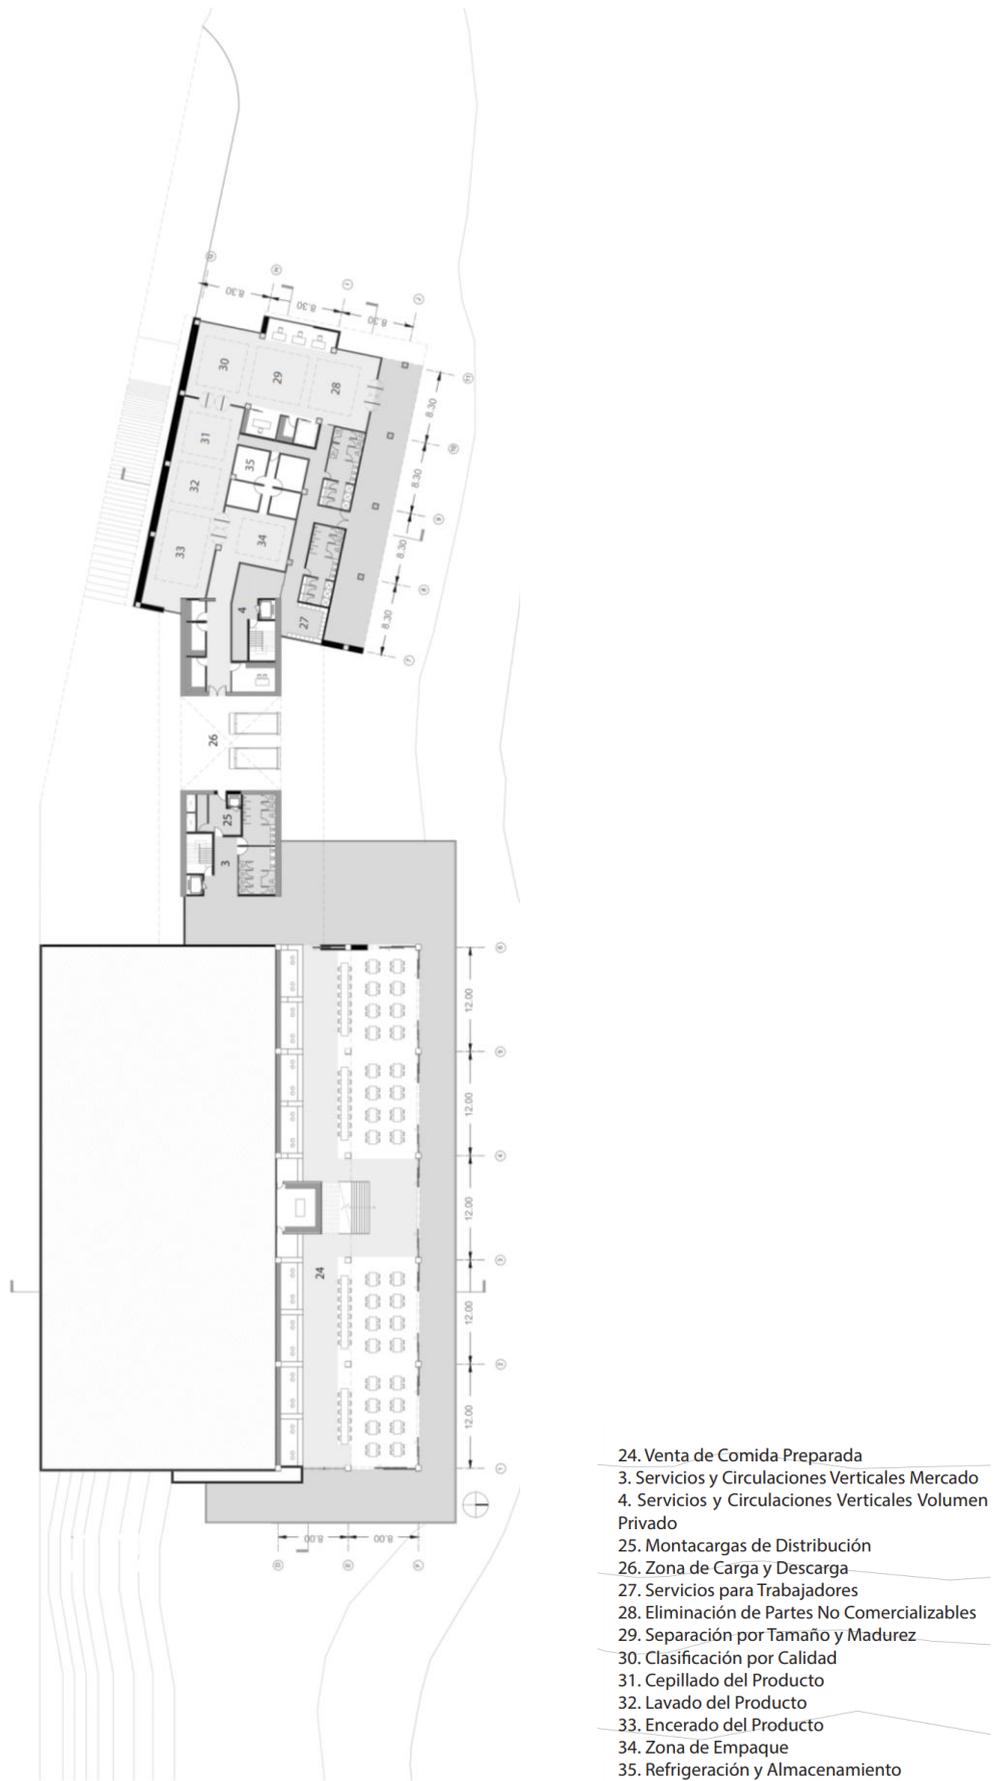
Elaboración Propia. Indicador: Planta Subsuelo Cuarta N.- 13.20m.
